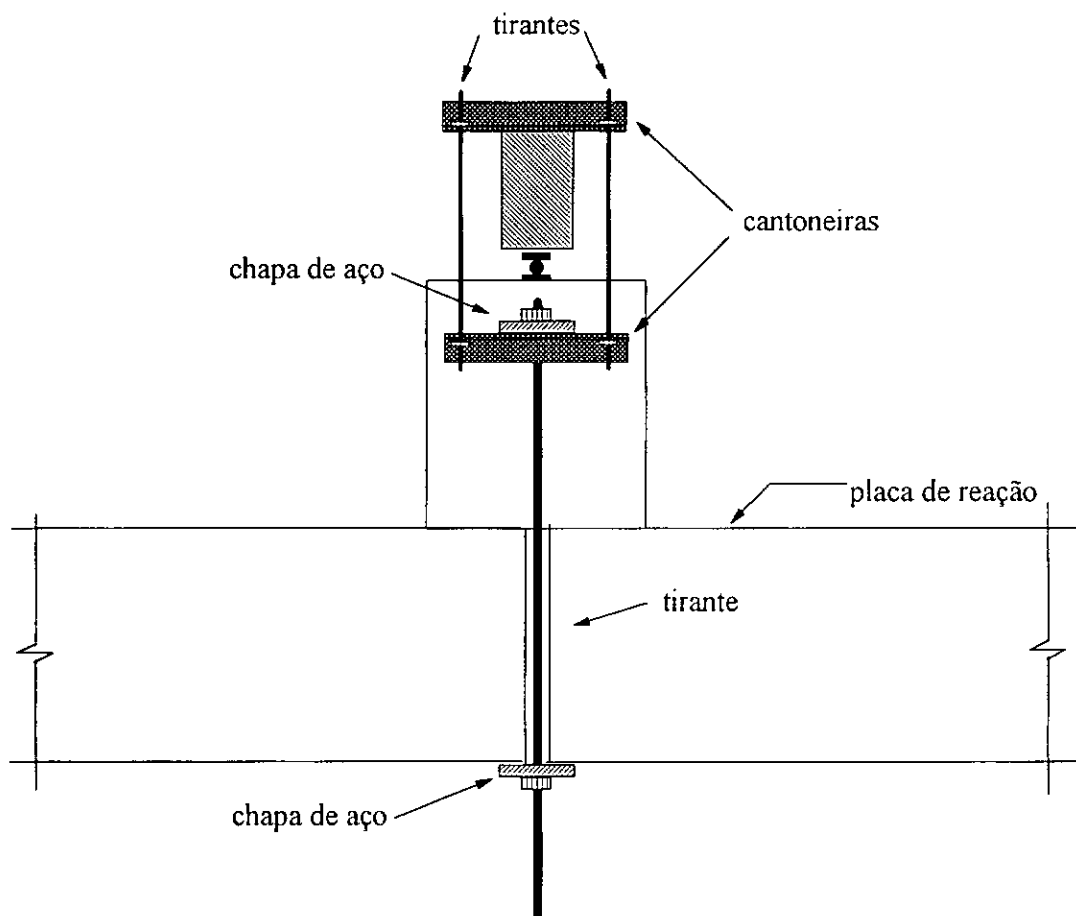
b - Sistema de escoramento adotado para manter o carregamento durante a execução do reforço da viga V2 - vista lateral
